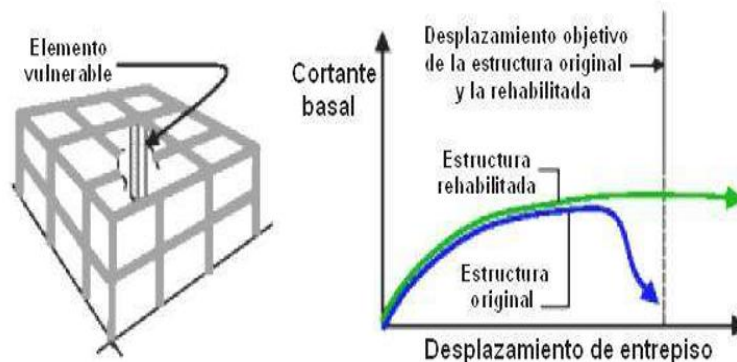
Reforzamiento del sistema a nivel elemento, Fuente: (Moehle, J,2000)
